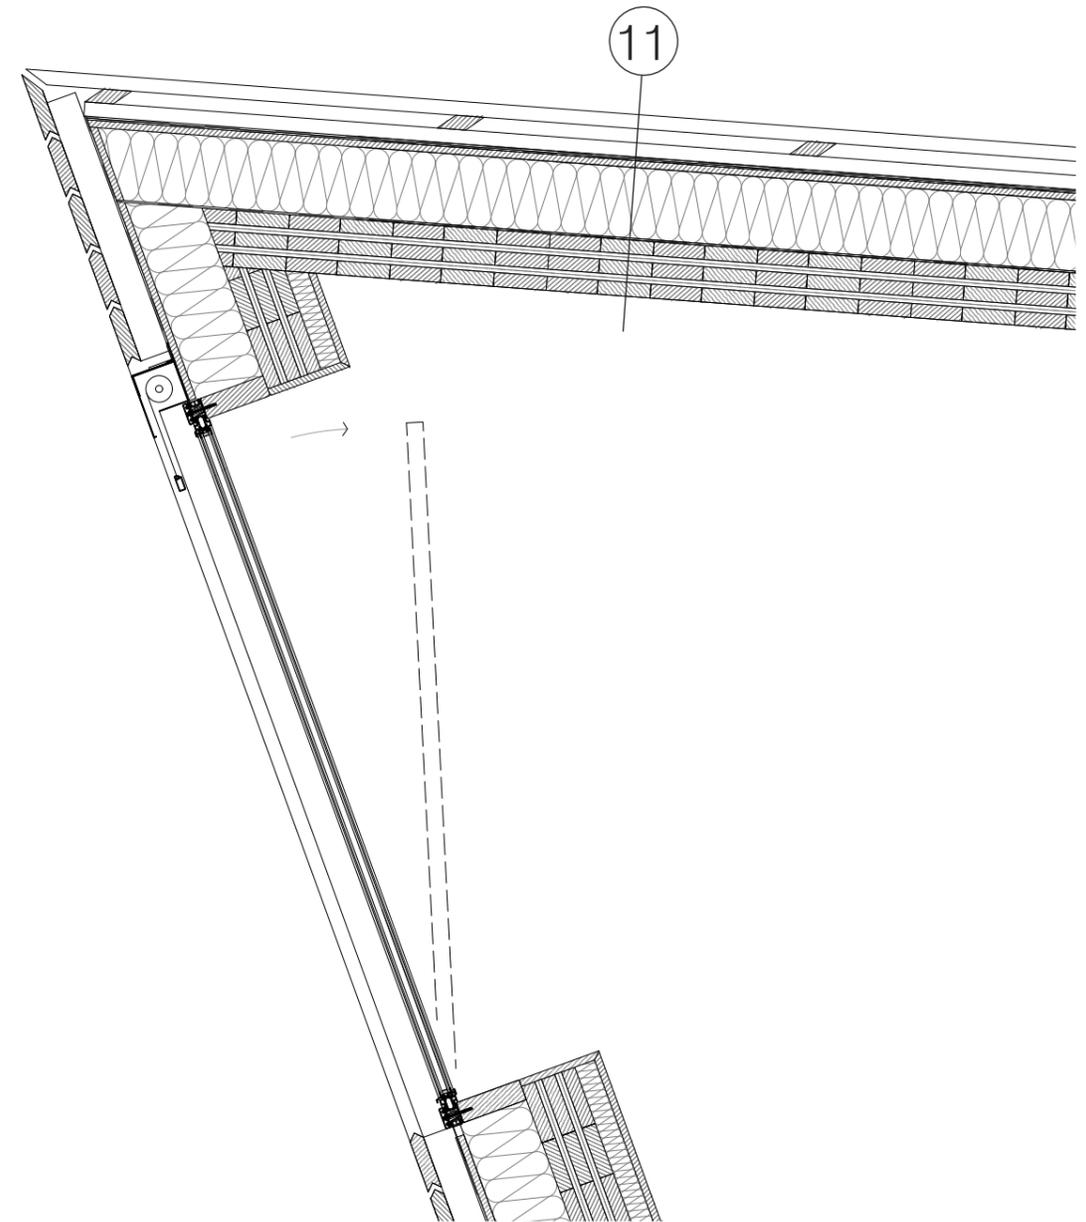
Fassadenschnitt 6 Deckendetail 1:20
